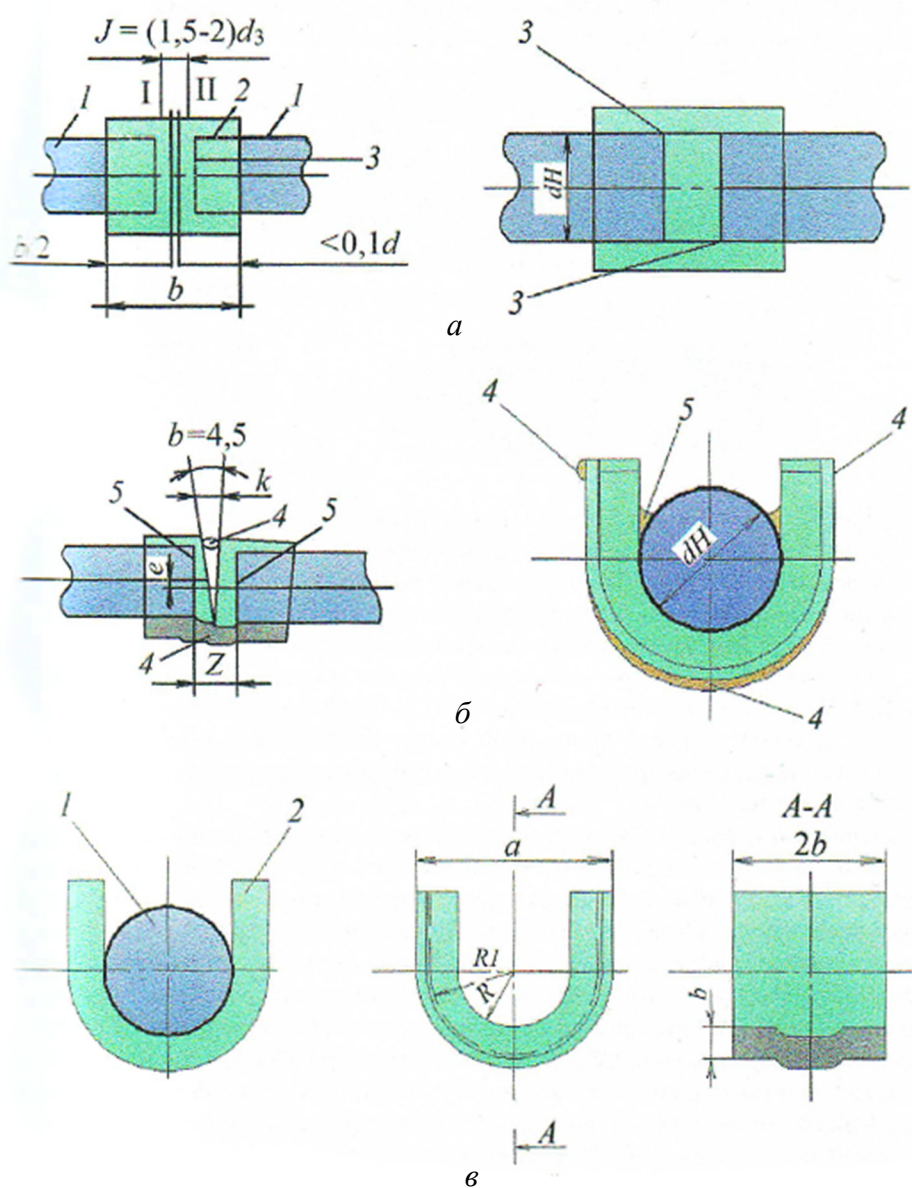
Пример соединения стержней с помощью ванной сварки: а – стык на гладкой накладке; б – стык на составной подплоскошке; в – цельная подкладка с канавками; 1 – стыкуемые стержни, 2 – подкладка, 3, 4, 5 – прихватки
